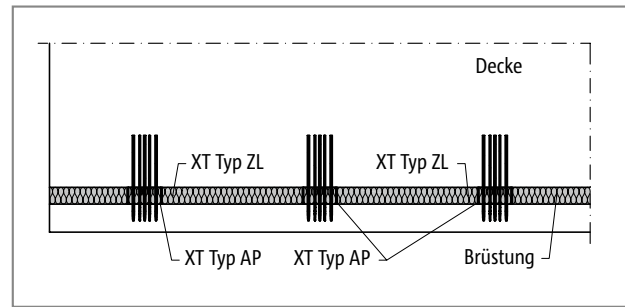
Schöck Isokorb® XT Typ AP horizontale Anordnung: Grundriss Brüstung vorgesetzt
